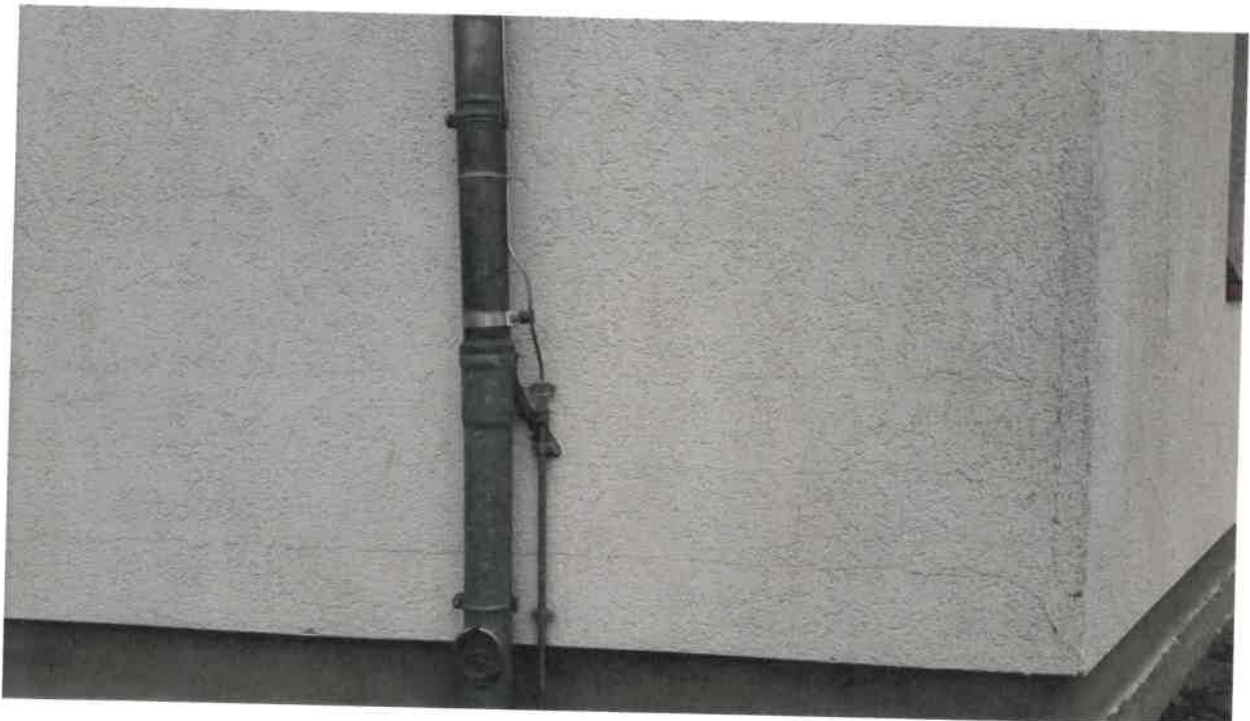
Nord-West-Ansicht, Anbau Bestand – Risse im Bereich Gebäudeecke (Steinfugen)
